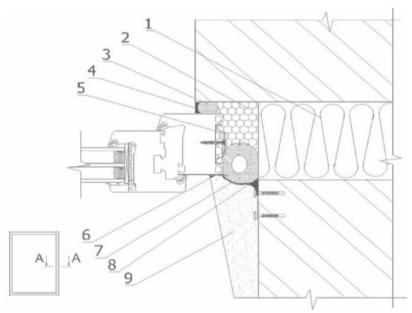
Узел примыкапия оконного блока к наружной степе с навесной фасадной системой теплоизоляции
